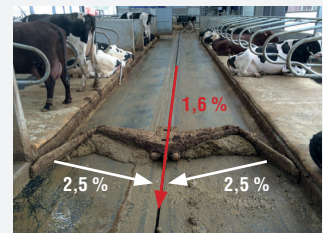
Schéma explicatif d'une pente longitudinale et d'une pente transversale d'après la plaquette IDELE « Quelles innovations pour éliminer l'humidité sur les sols pleins bétonnés des aires de circulation des animaux ? »
